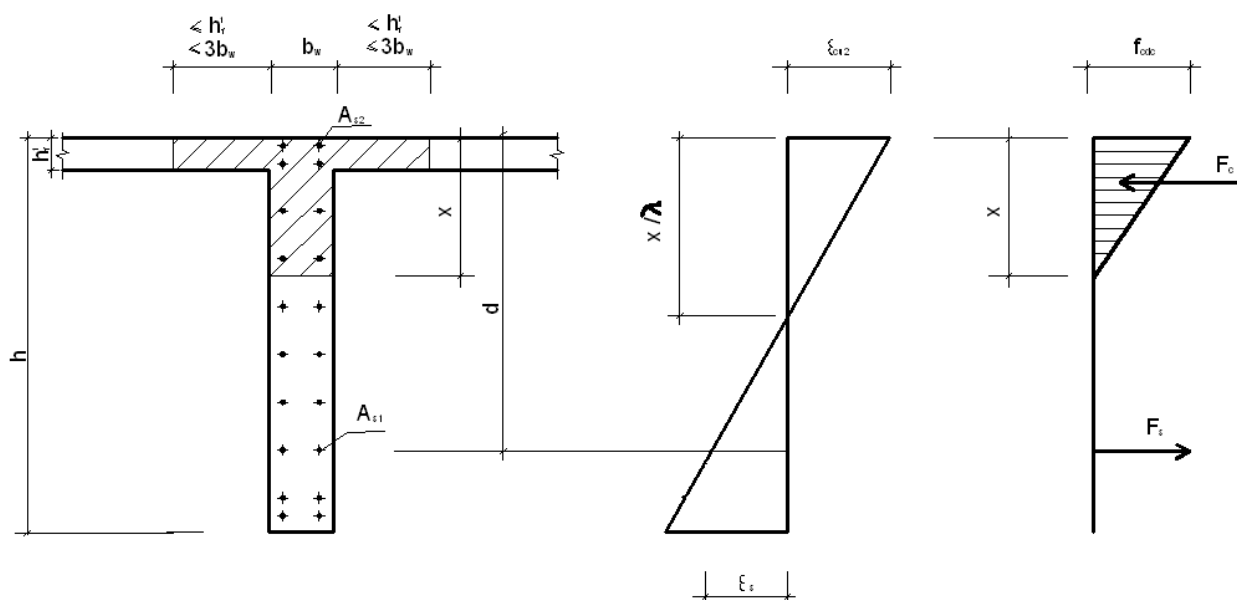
Распределение напряжений по высоте сжатой зоны стенового элемента
